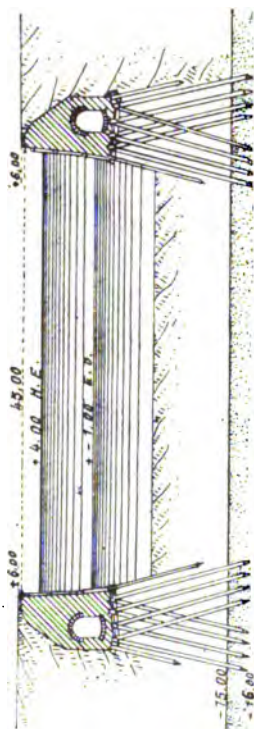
Ecluse Bremerhaven. — Coupe transversale.
